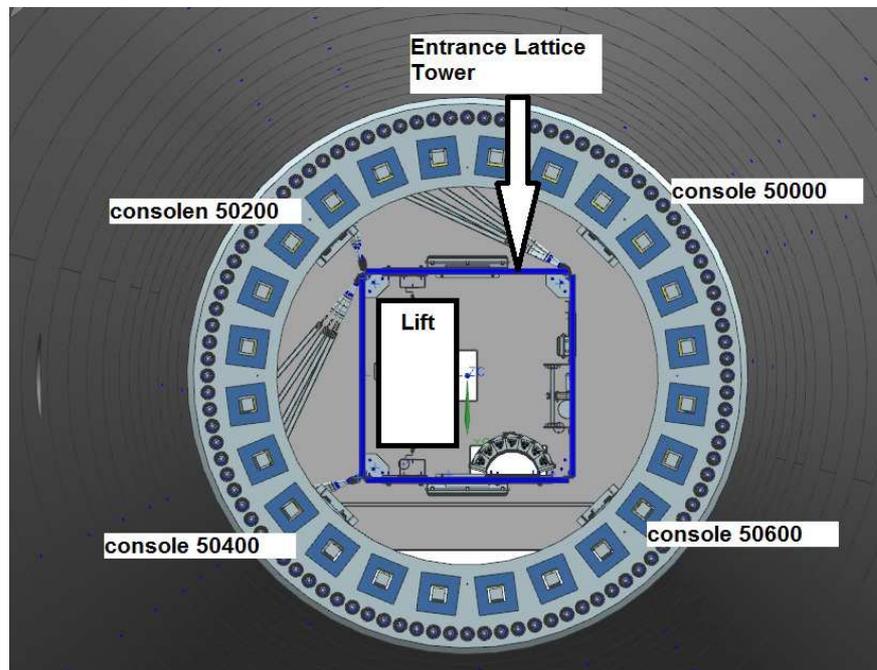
Beispiel Draufsicht Übergang Beton- zu Stahlurm / example top view transition concrete to steel tower
